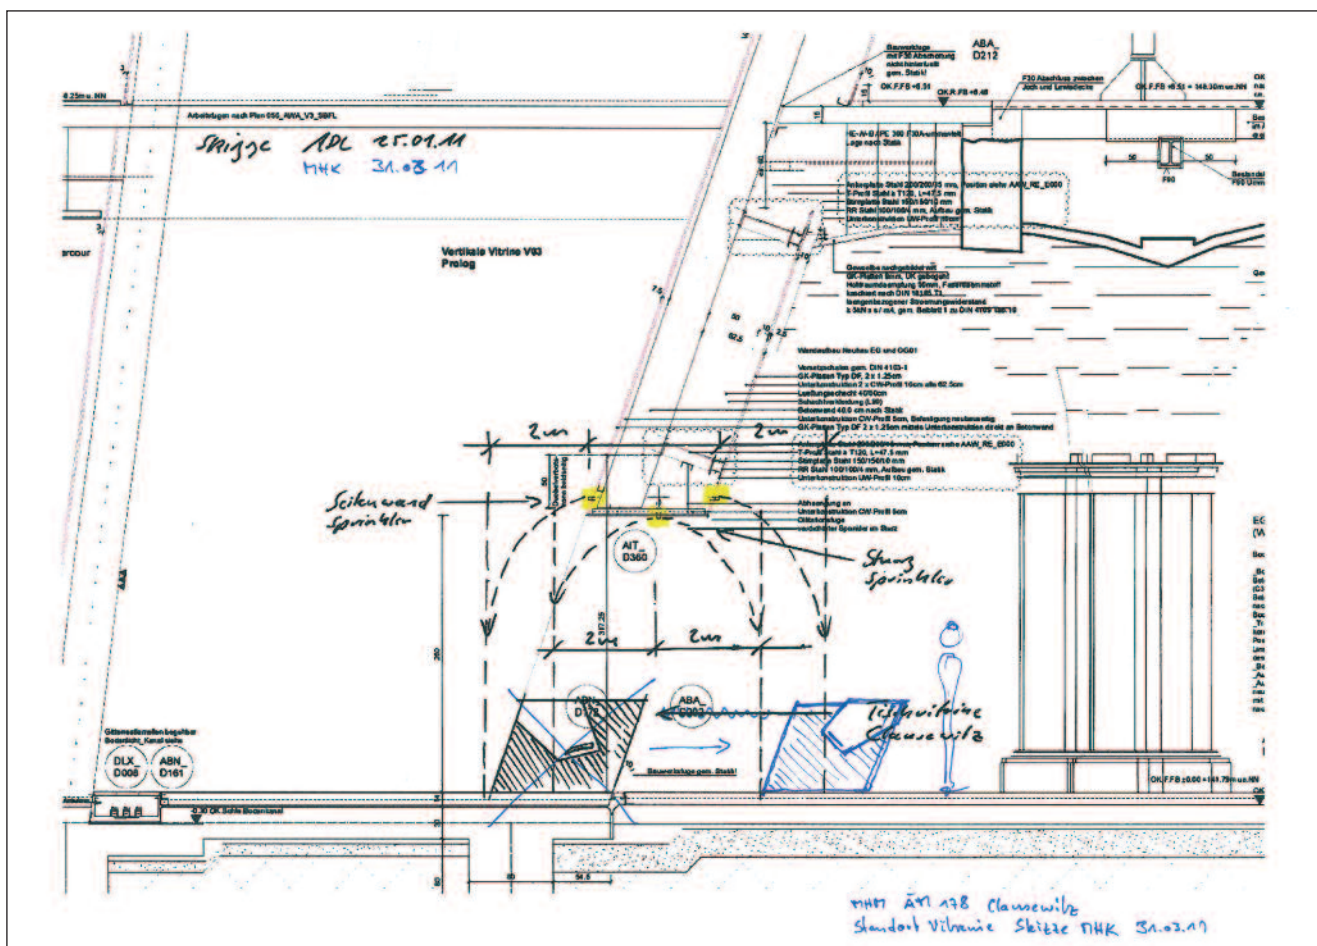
Sprühflutanlage als Öffnungsschutz, Vitrine muss in den erforderlichen Sprinklerschutz „versetzt“ werden
